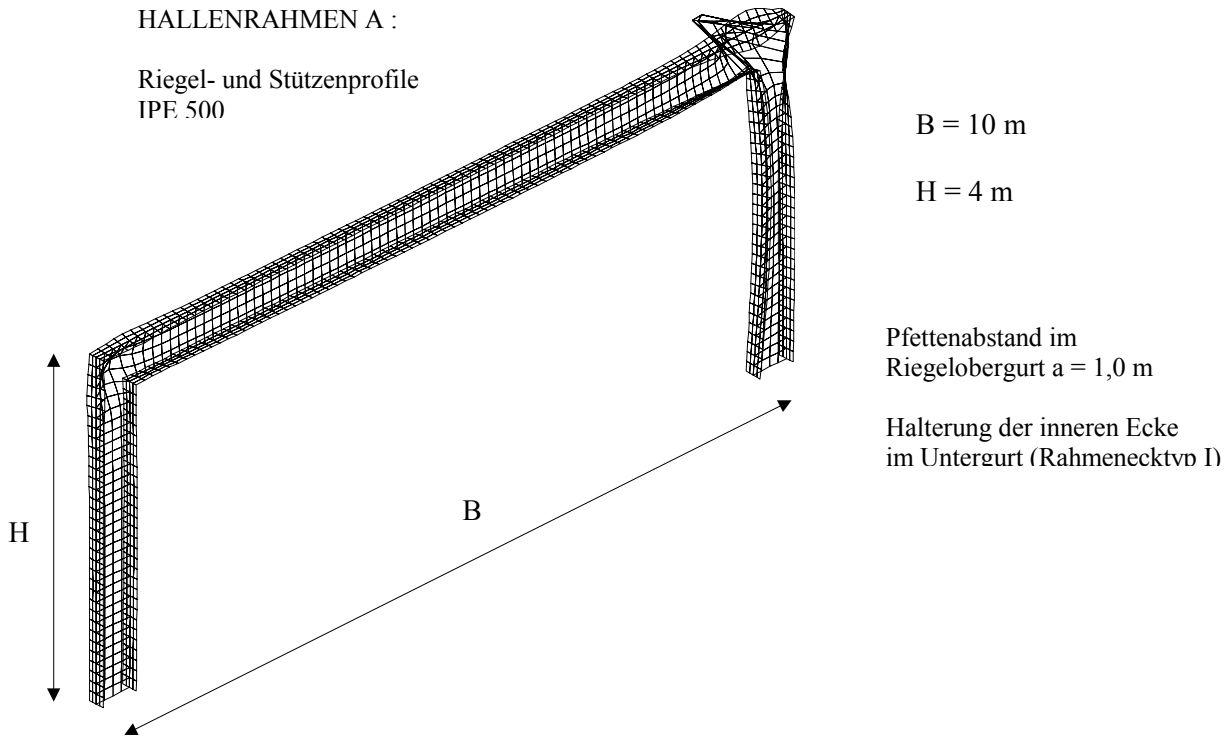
Stabilitätsversagen durch lokales Beulen im Eckbereich bei Hallenrahmen mit Halterung der inneren Ecke
